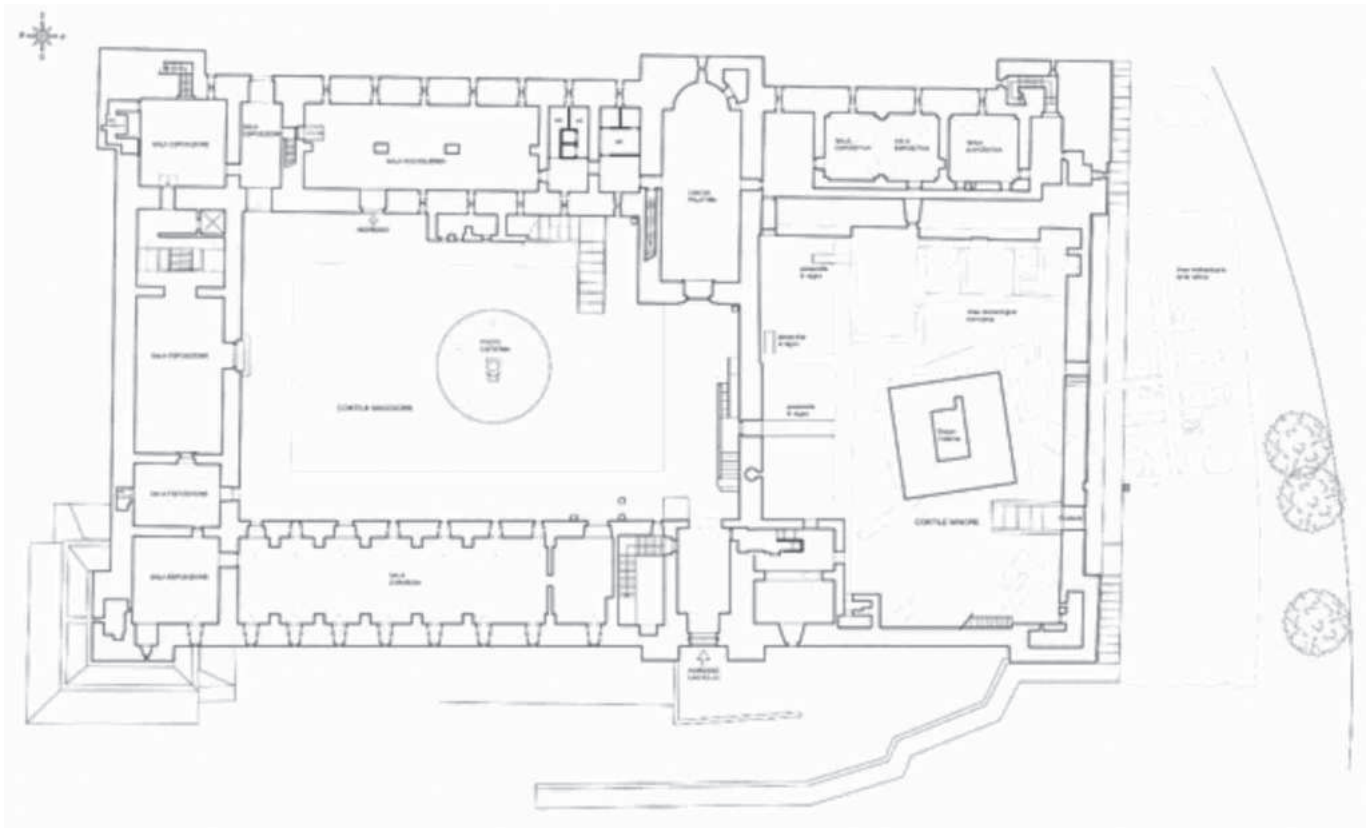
Planimetria del pianoterra del castello (foto dell'autore)
